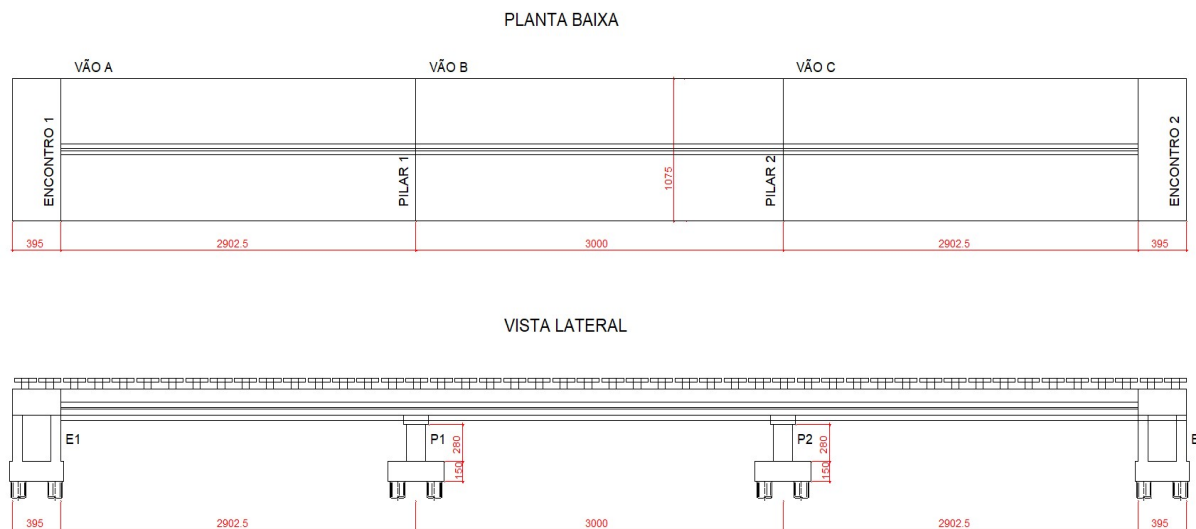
Planta baixa e Vista Lateral da Ponte Metroviária (dimensões em centímetros).
